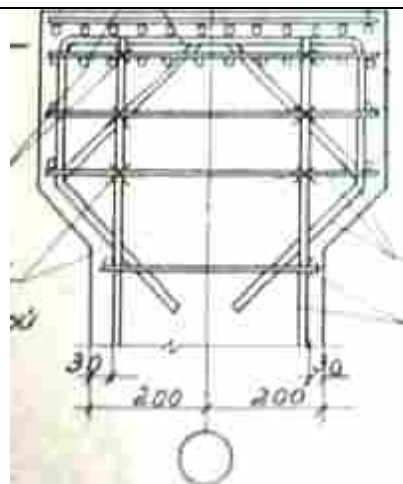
Схема армирования оголовка колонны КП II-23А.
